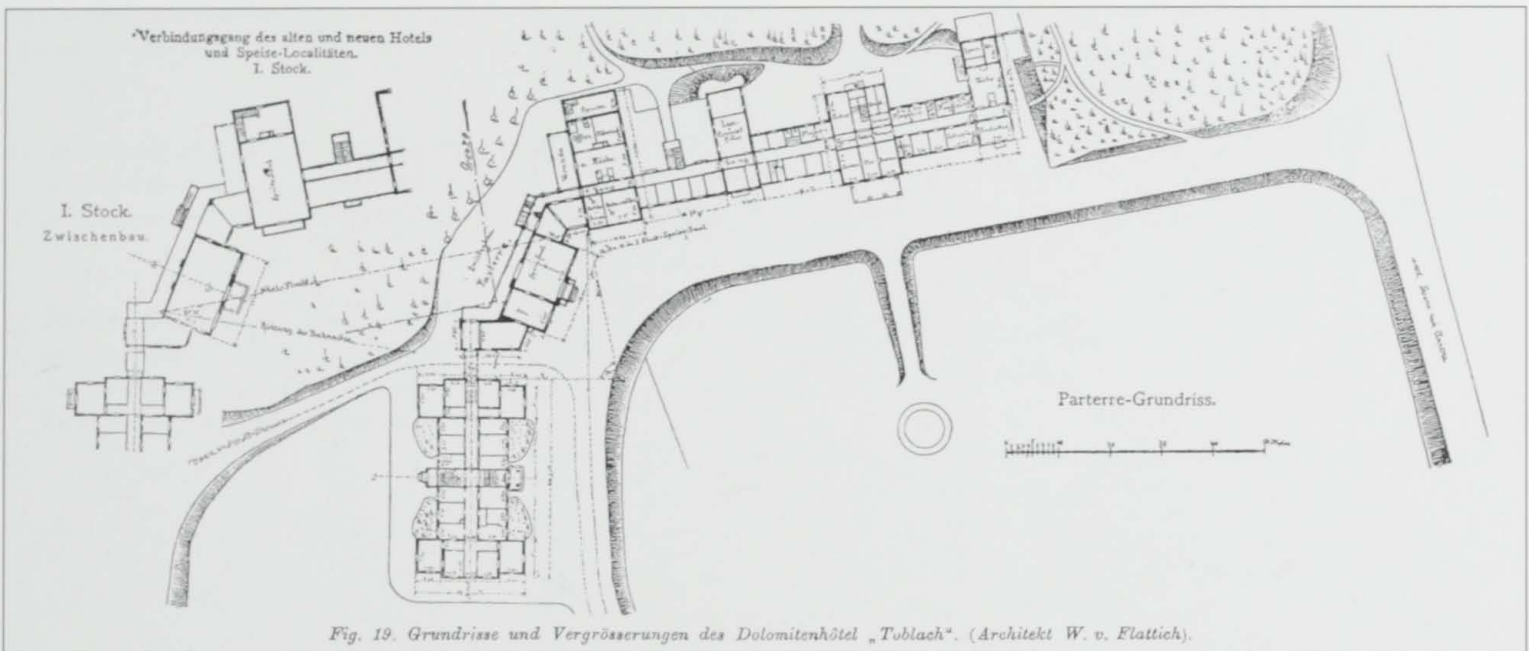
Grundrisse und Vergrößerungen des Dolomitenhôtél „Toblach“. (Architekt W. v. Flattich).
